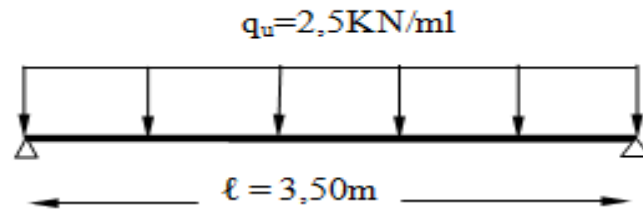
Schéma statique de la poutrelle et son chargement avant coulage de la dalle de compression
